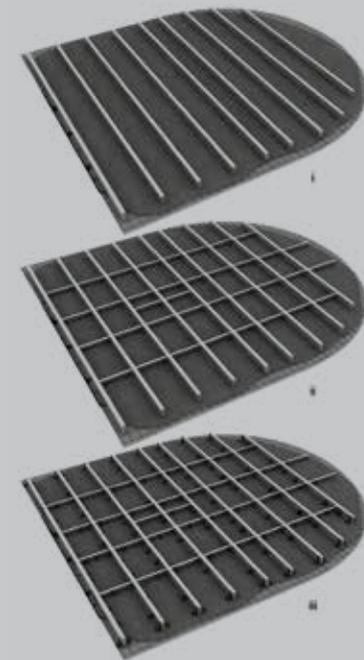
Ensamble del nuevo bastidor de acero inoxidable: i) instalación de vigas principales; ii) instalación de vigas secundarias; iii) instalación de conexiones entre vigas principales y secundarias e instalación de anclajes para unir el plafón al bastidor.
